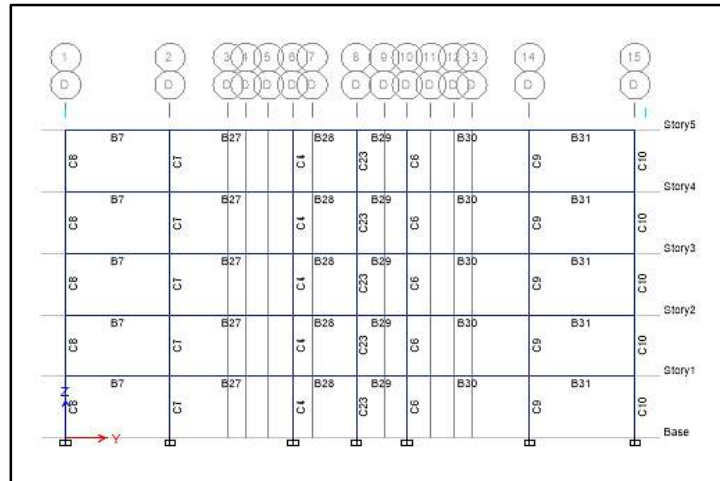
Vista de modelo de Eje en elevación con las secciones asignadas.
